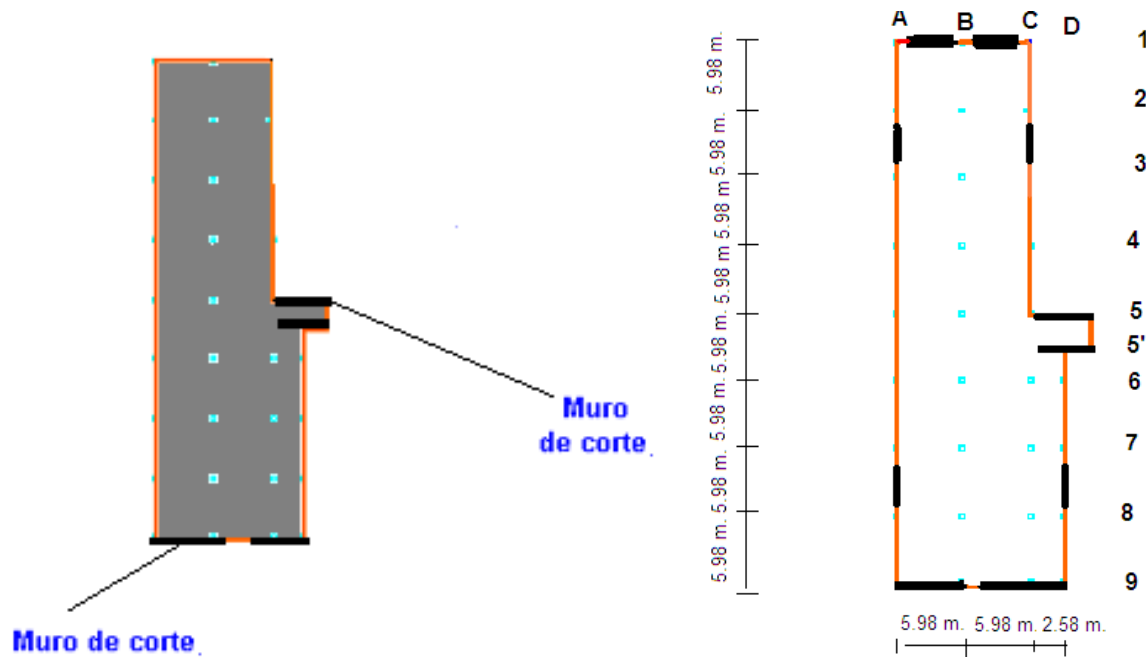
Bloque estructural original y propuesta de reforzamiento.
